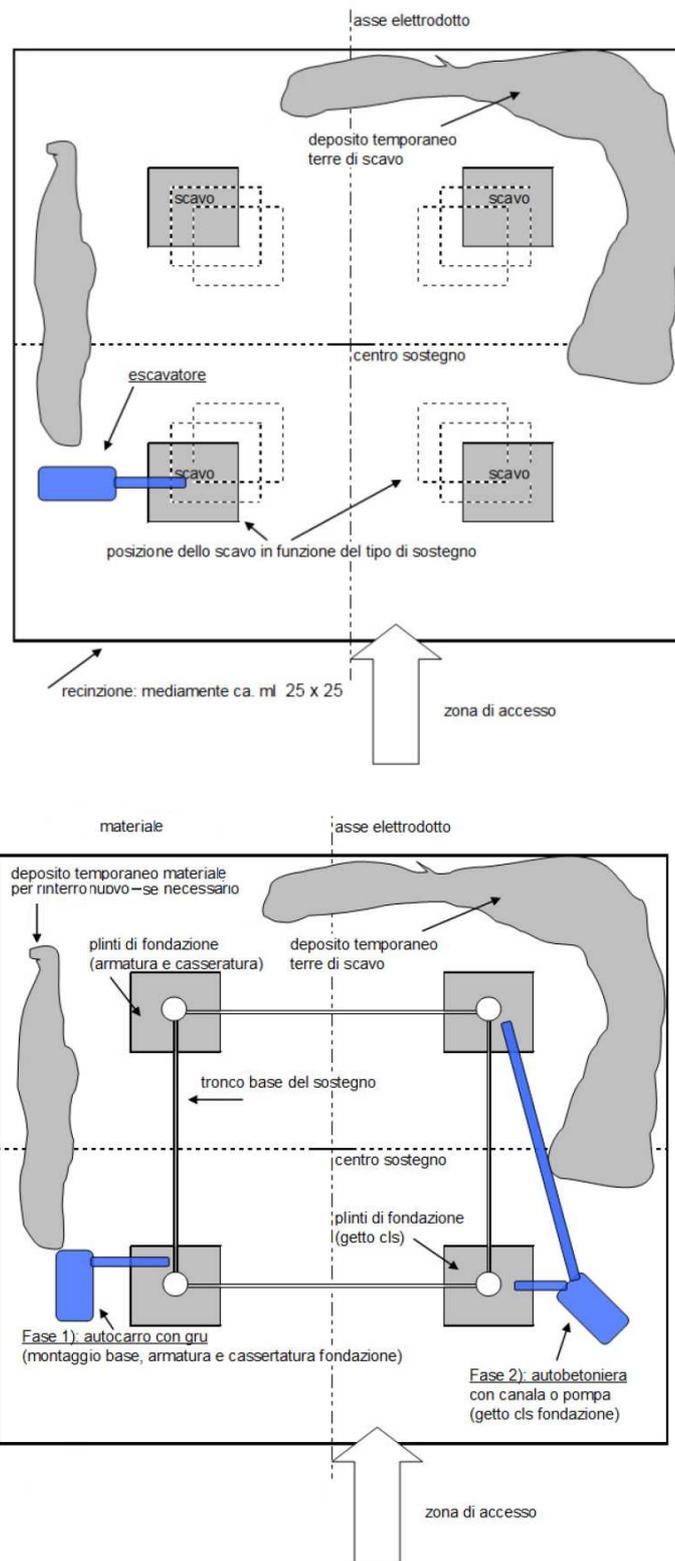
Planimetria tipologica dell'area di cantiere per scavi e getti
